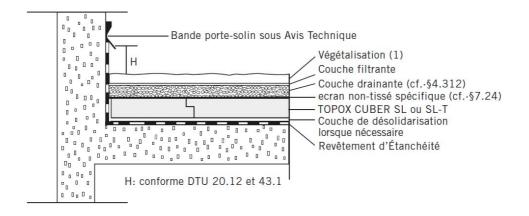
Coupe de principe d'une toiture terrasse jardin
